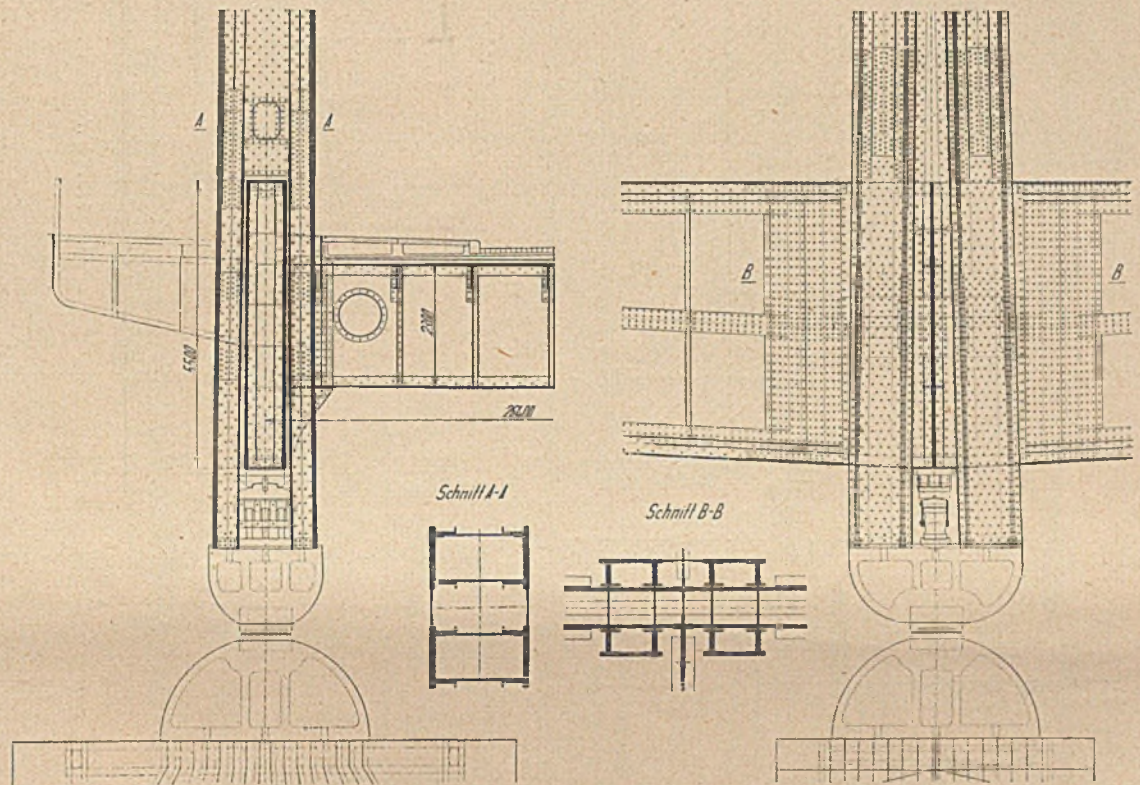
„Weltstadt“. Entwurf I. Pylonenfuß mit Versteifungsträger.
